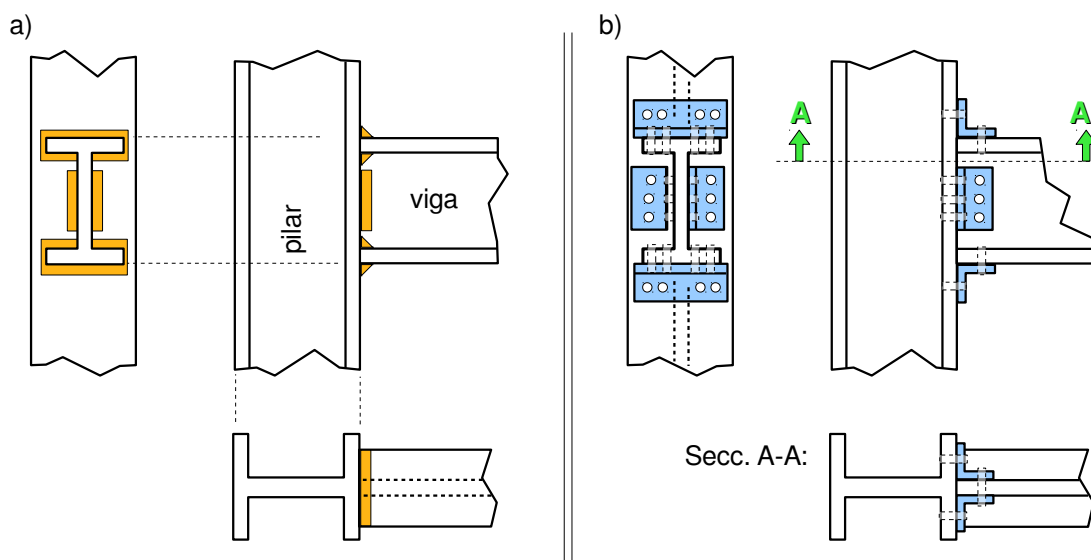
Ejemplo de unión de una viga con un pilar. a) Unión con soldadura. b) Unión con tornillos.
